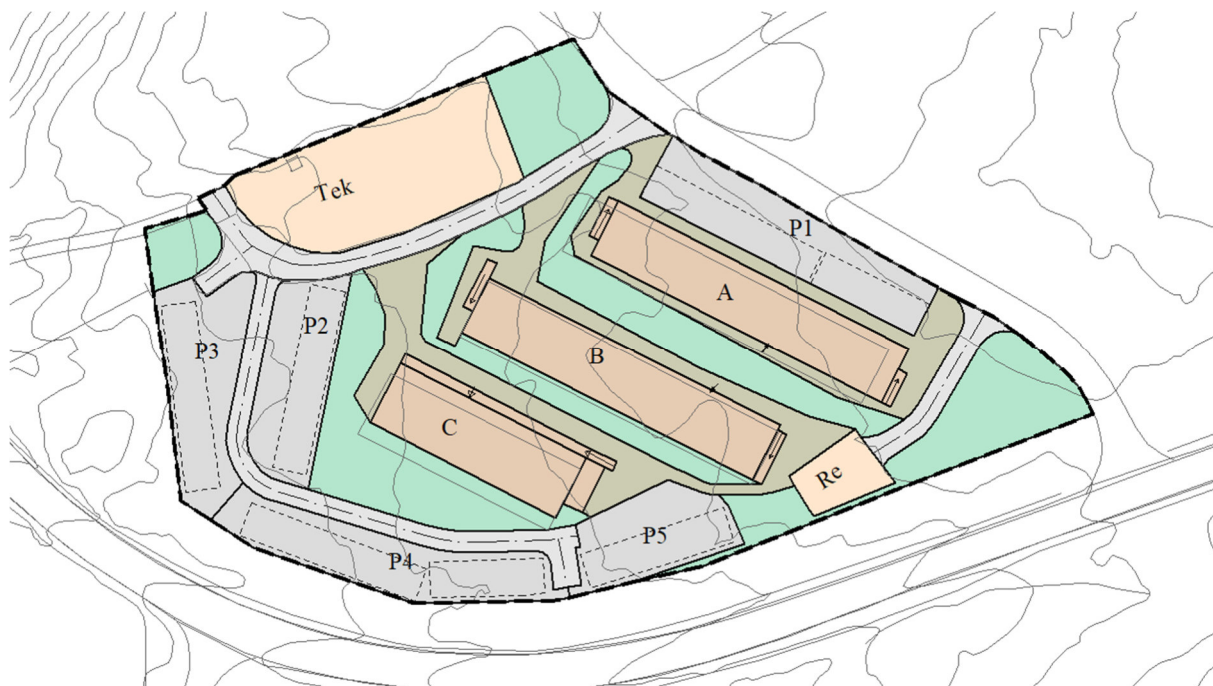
viser planavgrensning m/eks plan i bakgrunn
